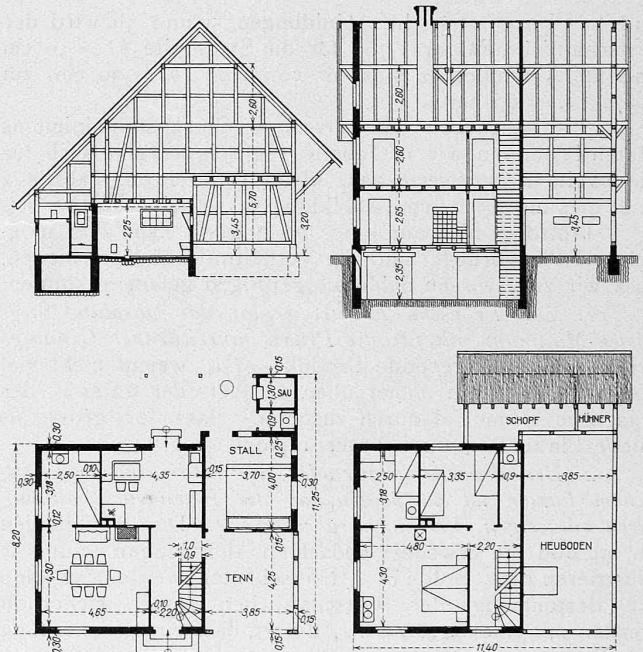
Grundrisse vom Erdgeschoss und vom 1. Stock sowie Schnitte vom Einfamilienhaus Typ A (und Typ C).
